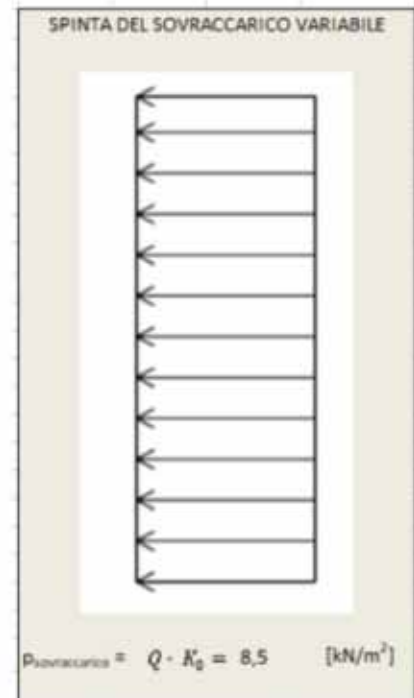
SPALLE A e B – Spinta sovraccarico variabile
